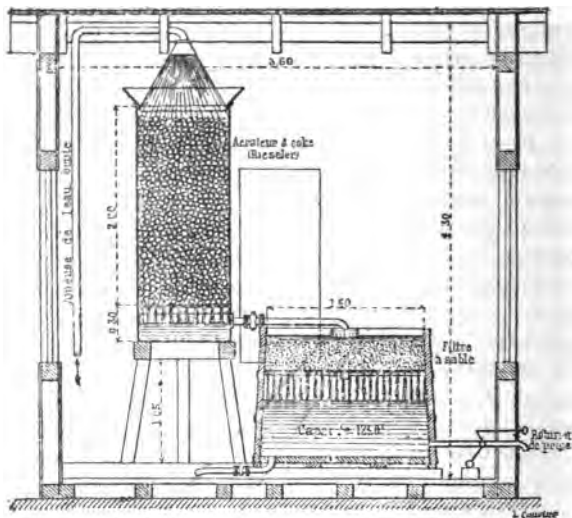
Appareil de Piefke (d'après MM. Debaue et Imbeaux).
